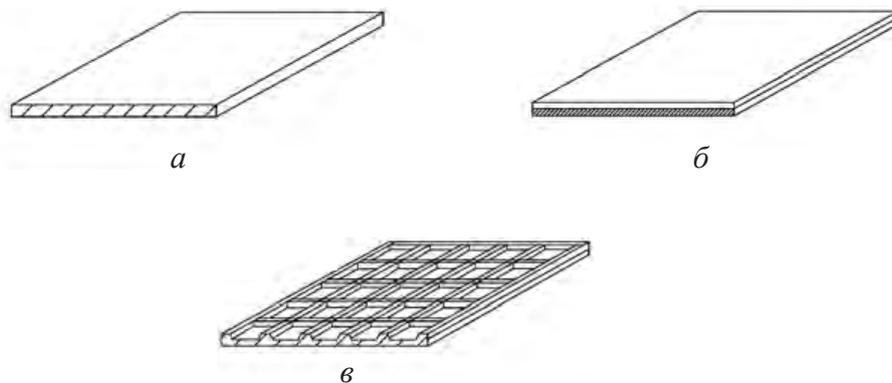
Виды панелей перекрытий: *a* — из сплошных железобетонных плит; *б* — из сплошных плит с ребрами по контуру; *в* — двухслойные из ребристых плит (плит с подшивным потолком)
